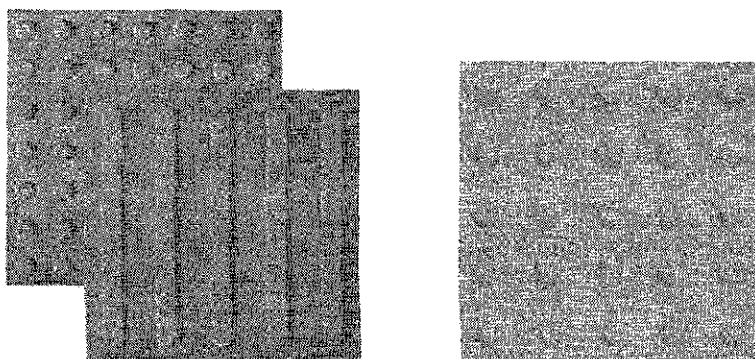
imagens exemplificativas de piso tátil de concreto – Cores: vermelha e amarelo
